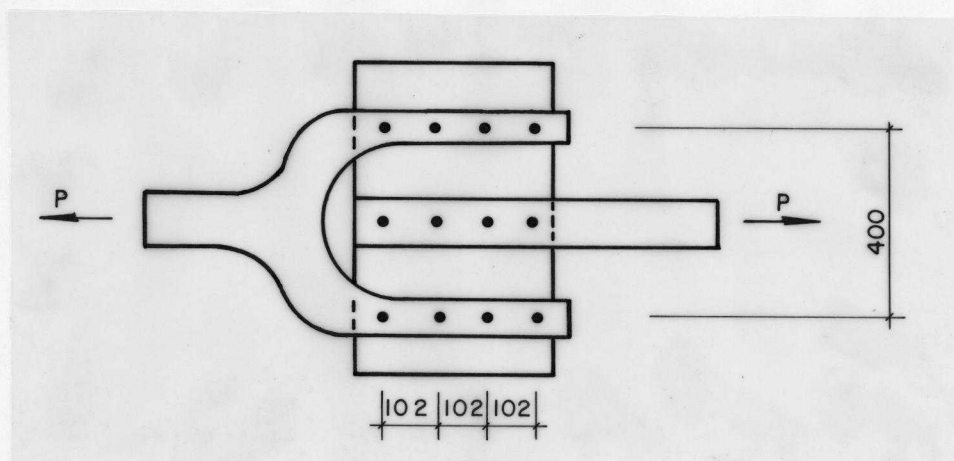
Garras para Ensaio de Conexões Parafusadas de Chapas Corrugadas com Esforços Transversais
